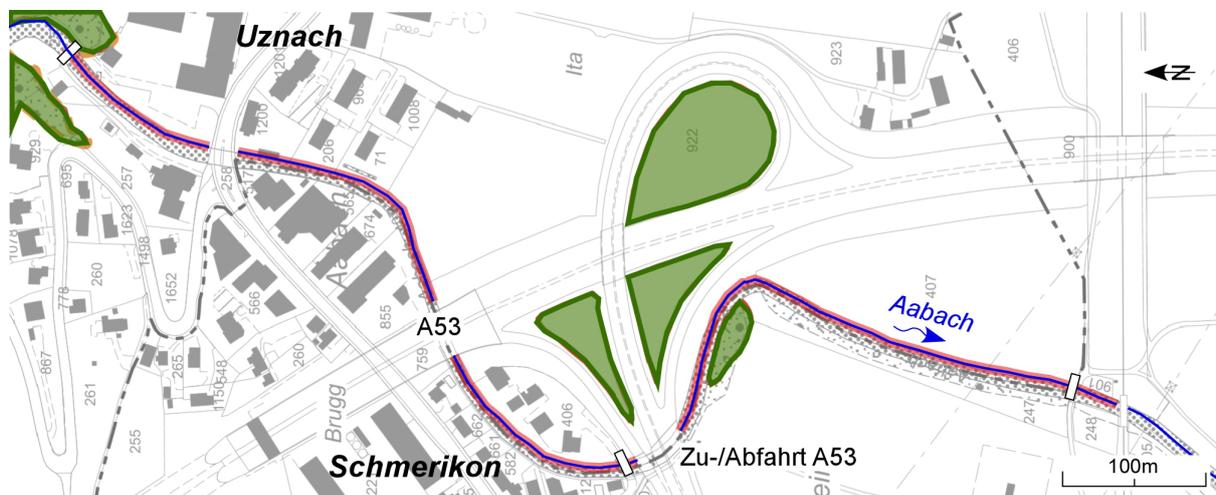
Situation mit Projektstrecke (rote Linie) und Basiswald [7] (grüne Flächen).
